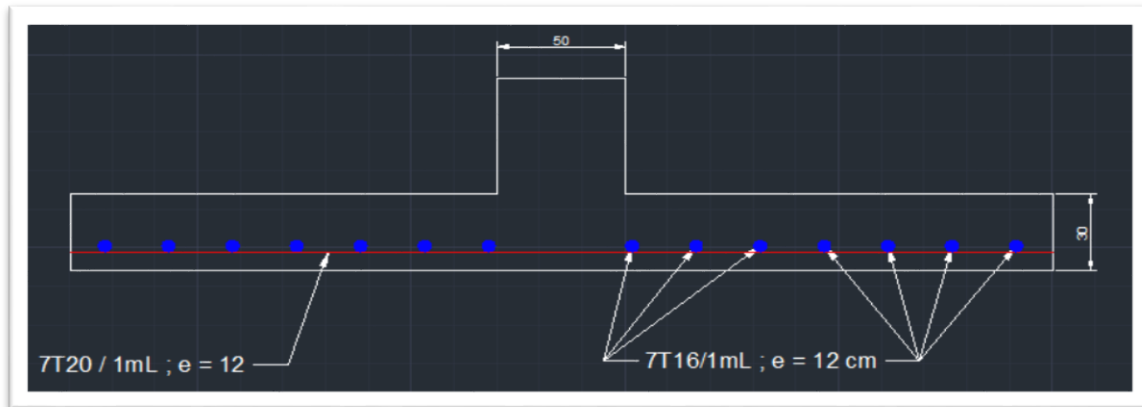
Schéma du ferrailage de la dalle pleine du radier (coupe parallèle à L_x)
